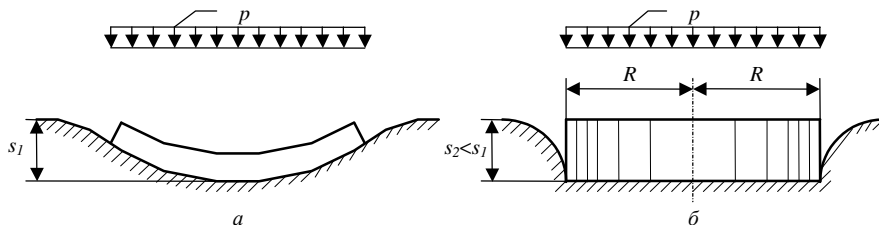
Деформування поверхні ґрунту при дії рівномірно розподіленого навантаження: а - гнучка площадка передачі навантаження; б - жорсткий круглий штамп
